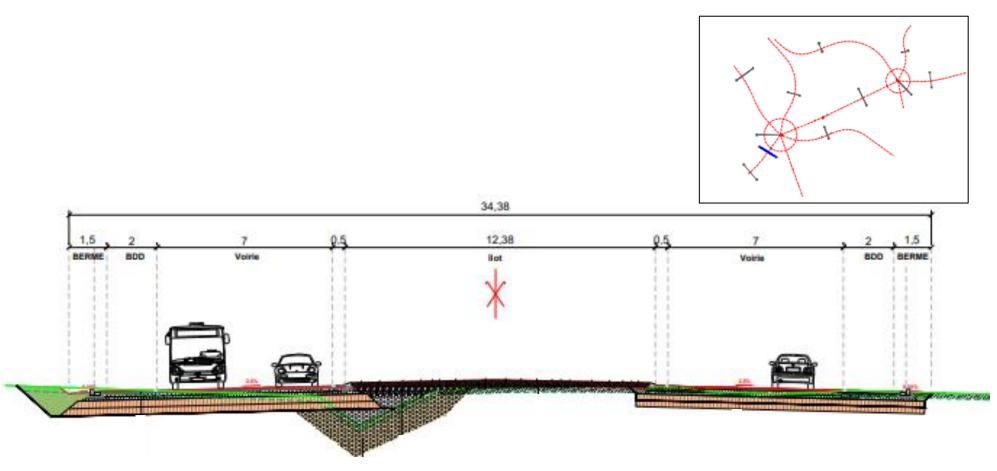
Profil en travers de la RD 650 Sud au 1/100 (Source Ingerop)
